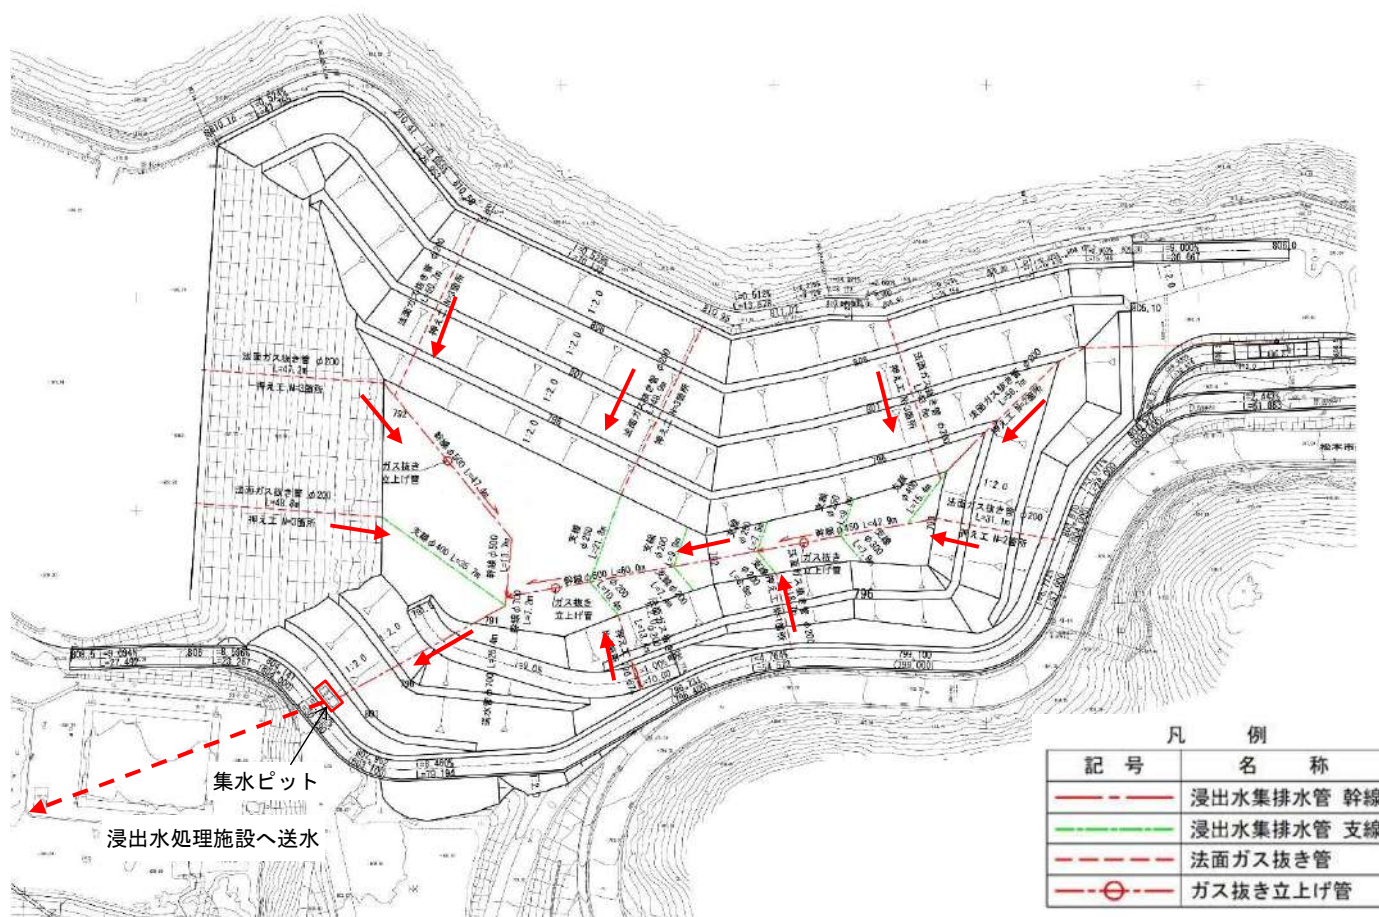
浸出水集排水施設及び埋立ガス処理施設平面図
